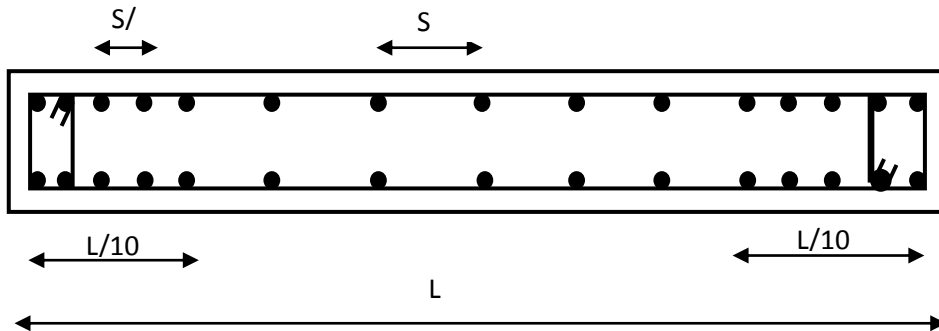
Disposition des armatures verticales (vue en plan).
